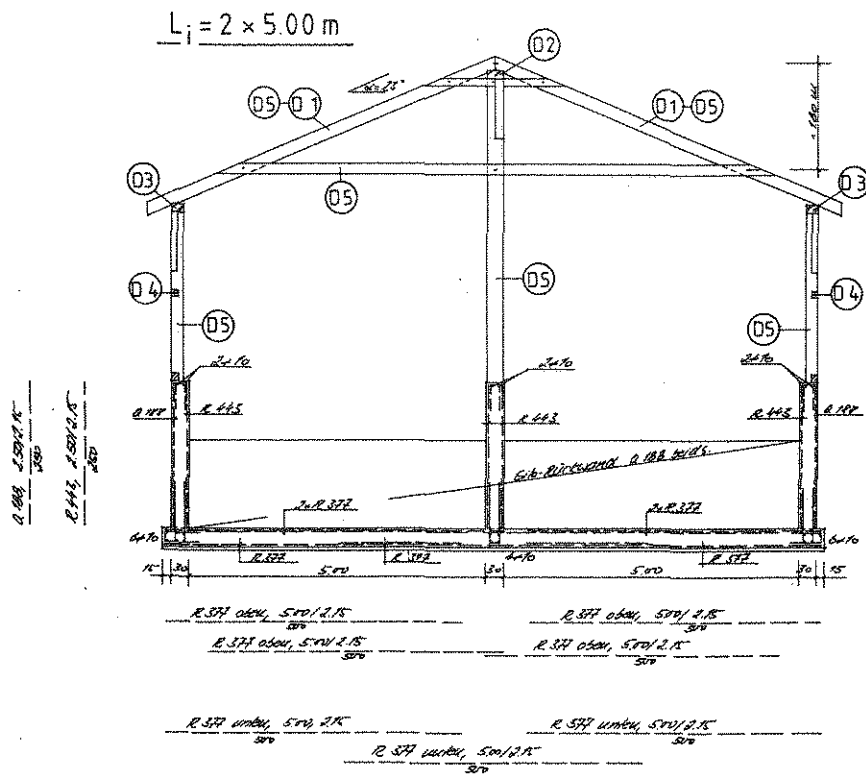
Bewehrung eines Fahrsilo mit Dach
